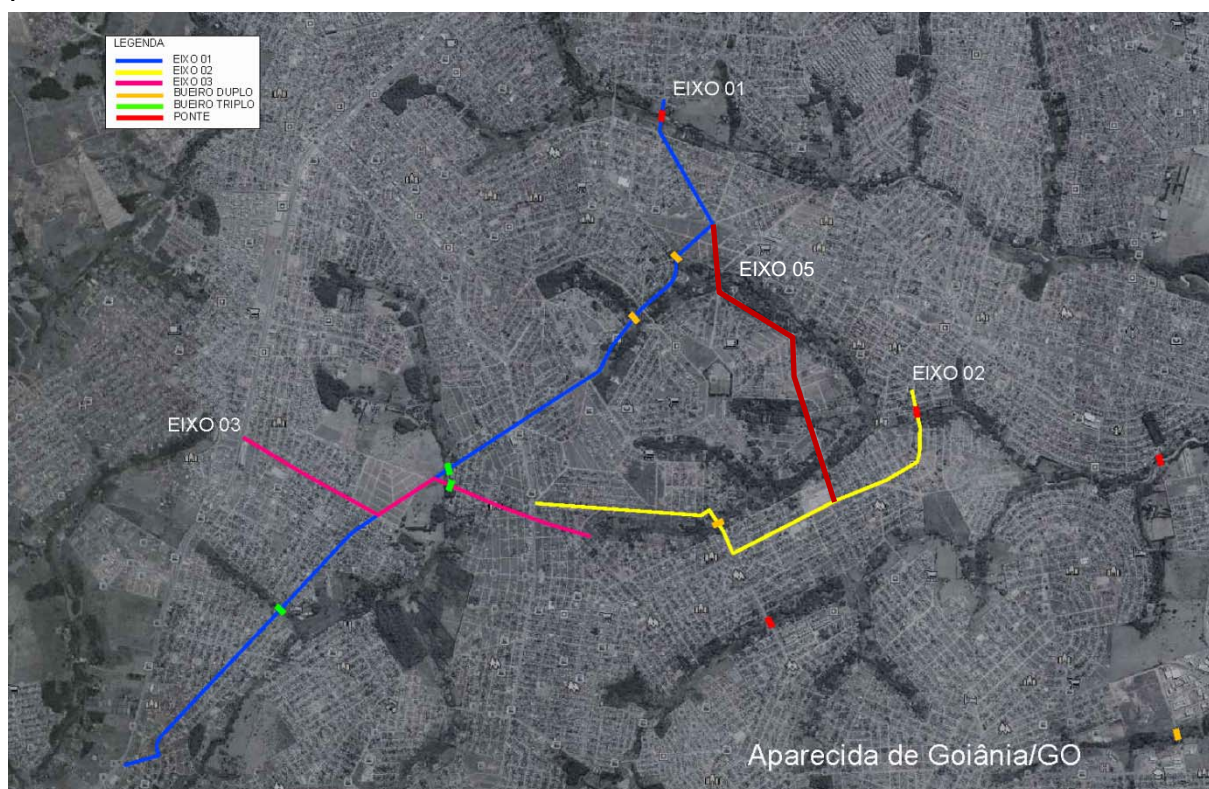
Planta de Situação dos Eixos Estruturantes.
